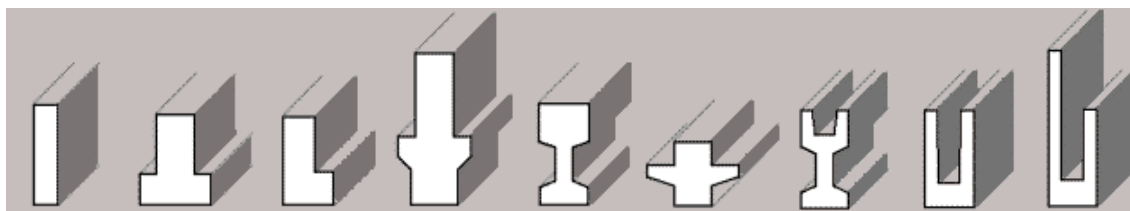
Seções típicas de pré-moldados em concreto protendido.
